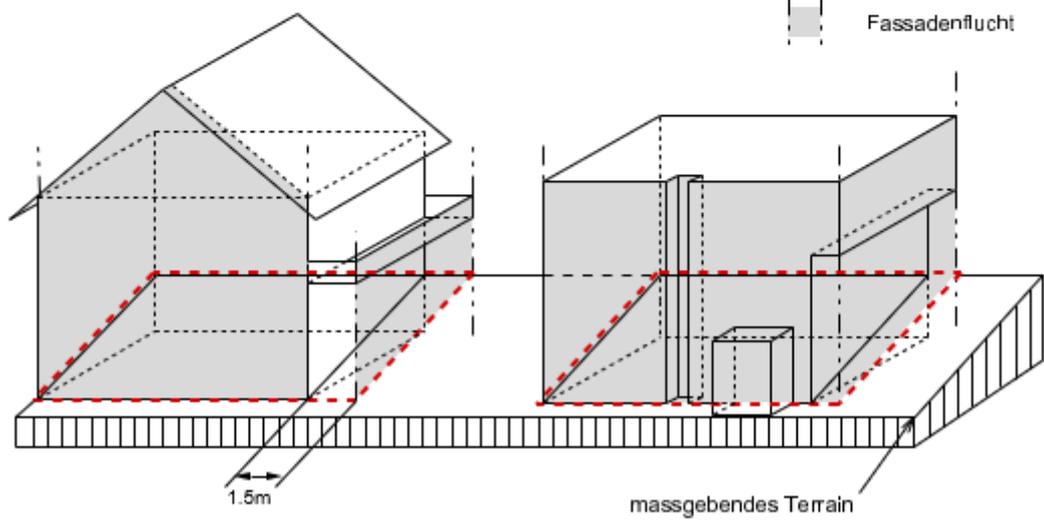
Fassadenflucht und Fassadenlinie (§16 und §17)
